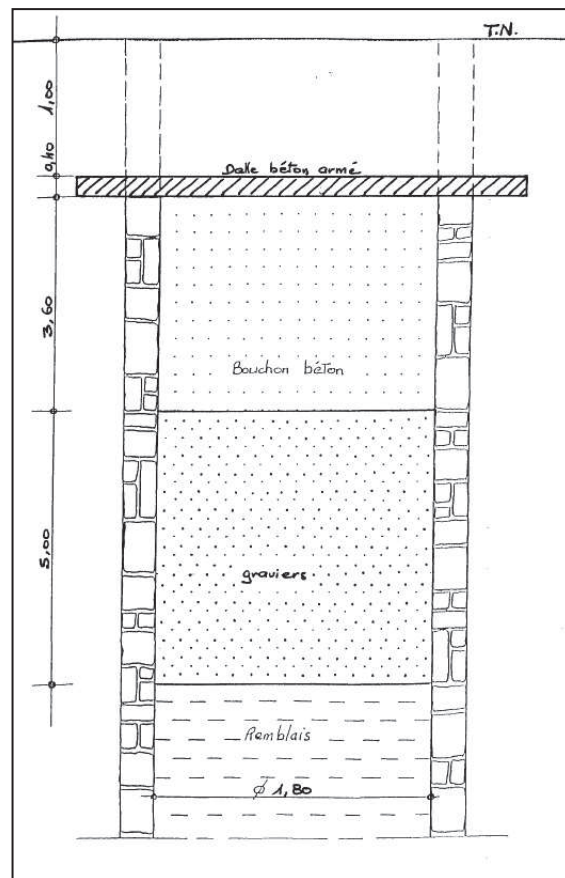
Schéma de mise en place du bouchon béton du puits des Echelles
